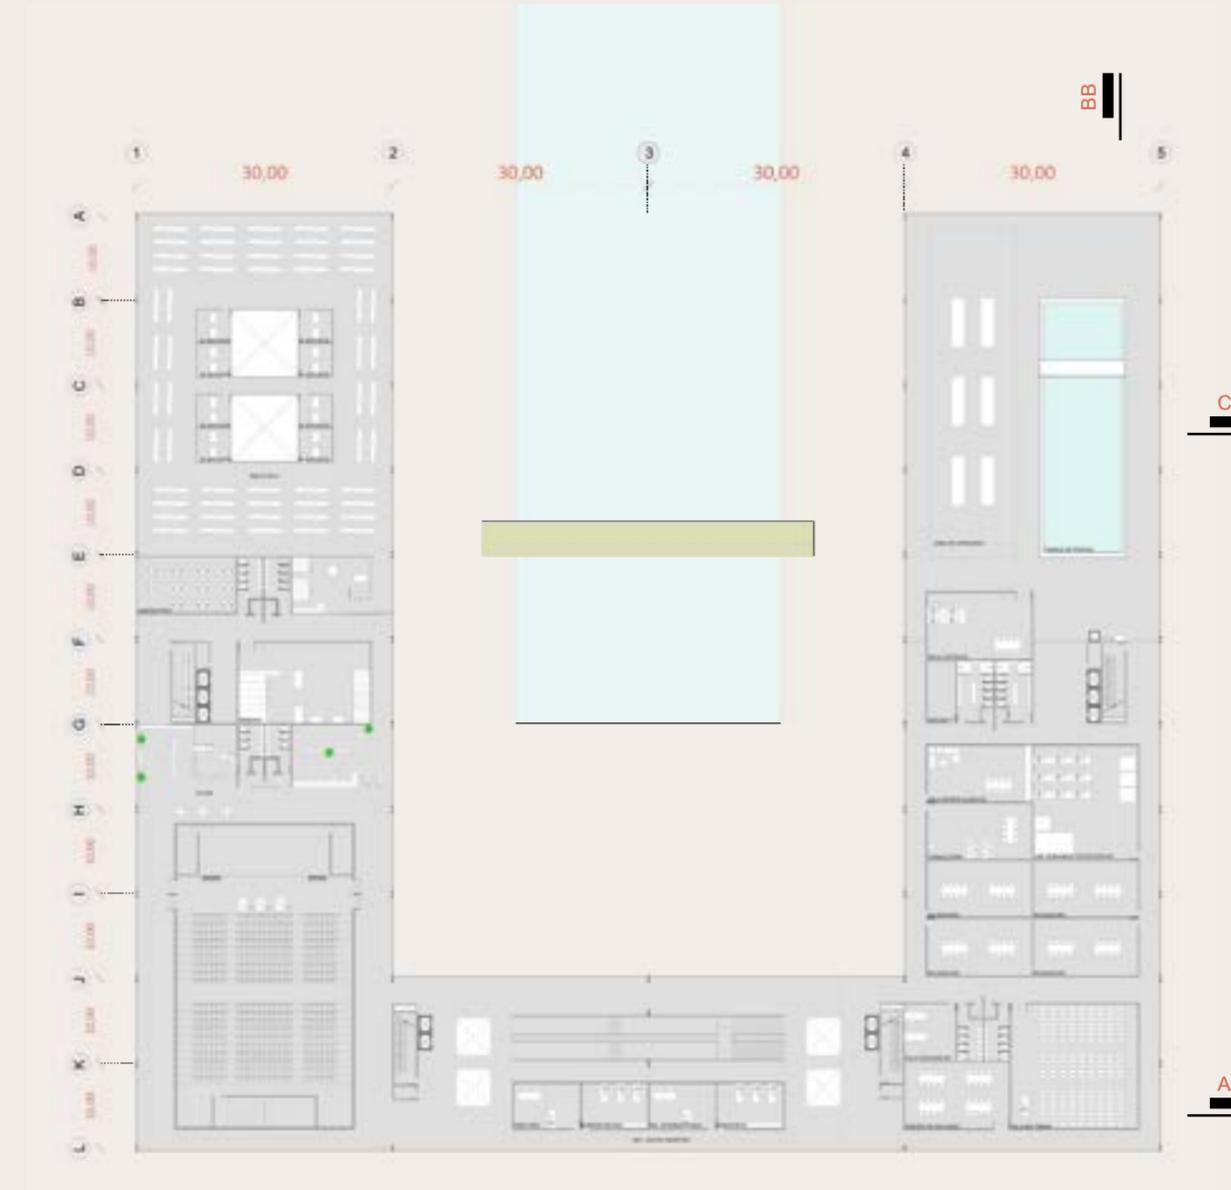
Planta técnica, 1º pavimento. Fonte: autoria própria.
